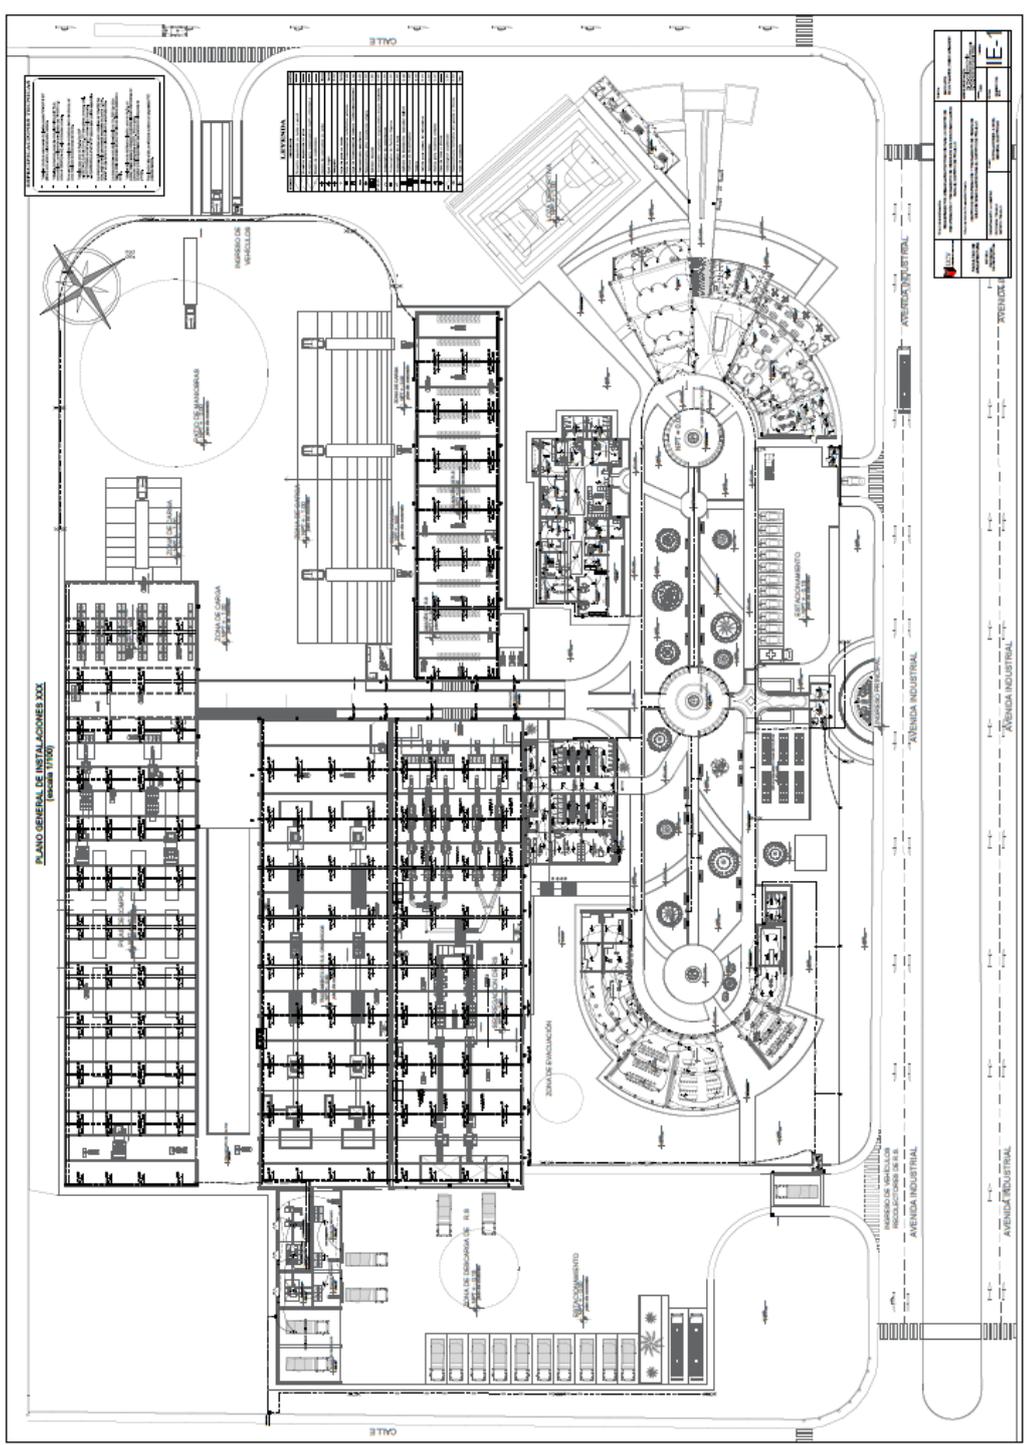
Plano de instalaciones eléctricas 1, Fuente: Elaboración propia, Trujillo-2018
